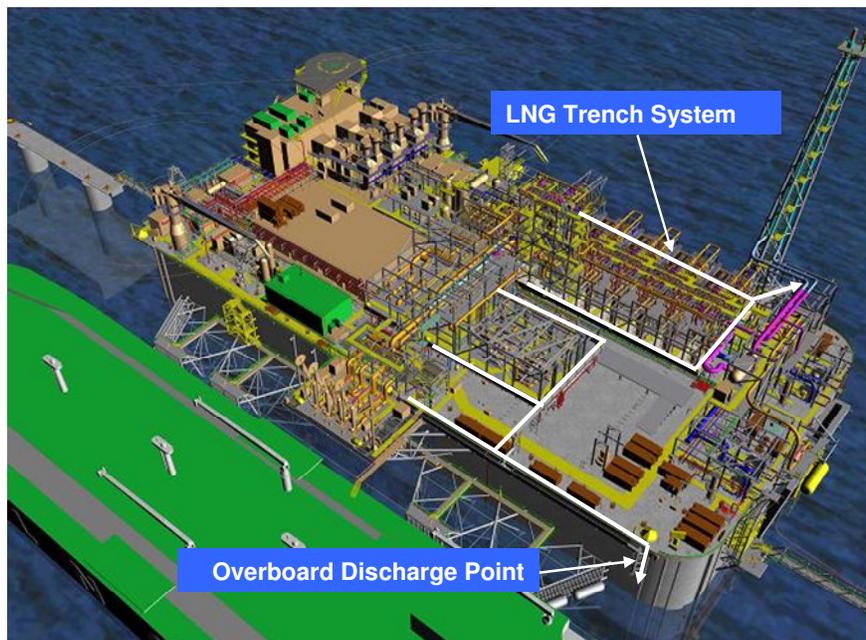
Schema dell’impianto di collettamento perdite LNG
